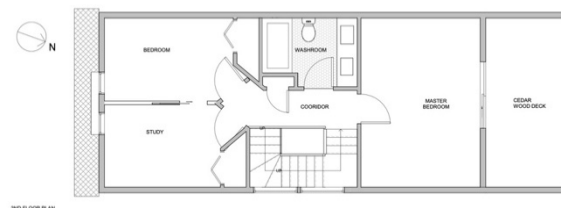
Torrens House, Planta Piso 1<sup>10</sup>
